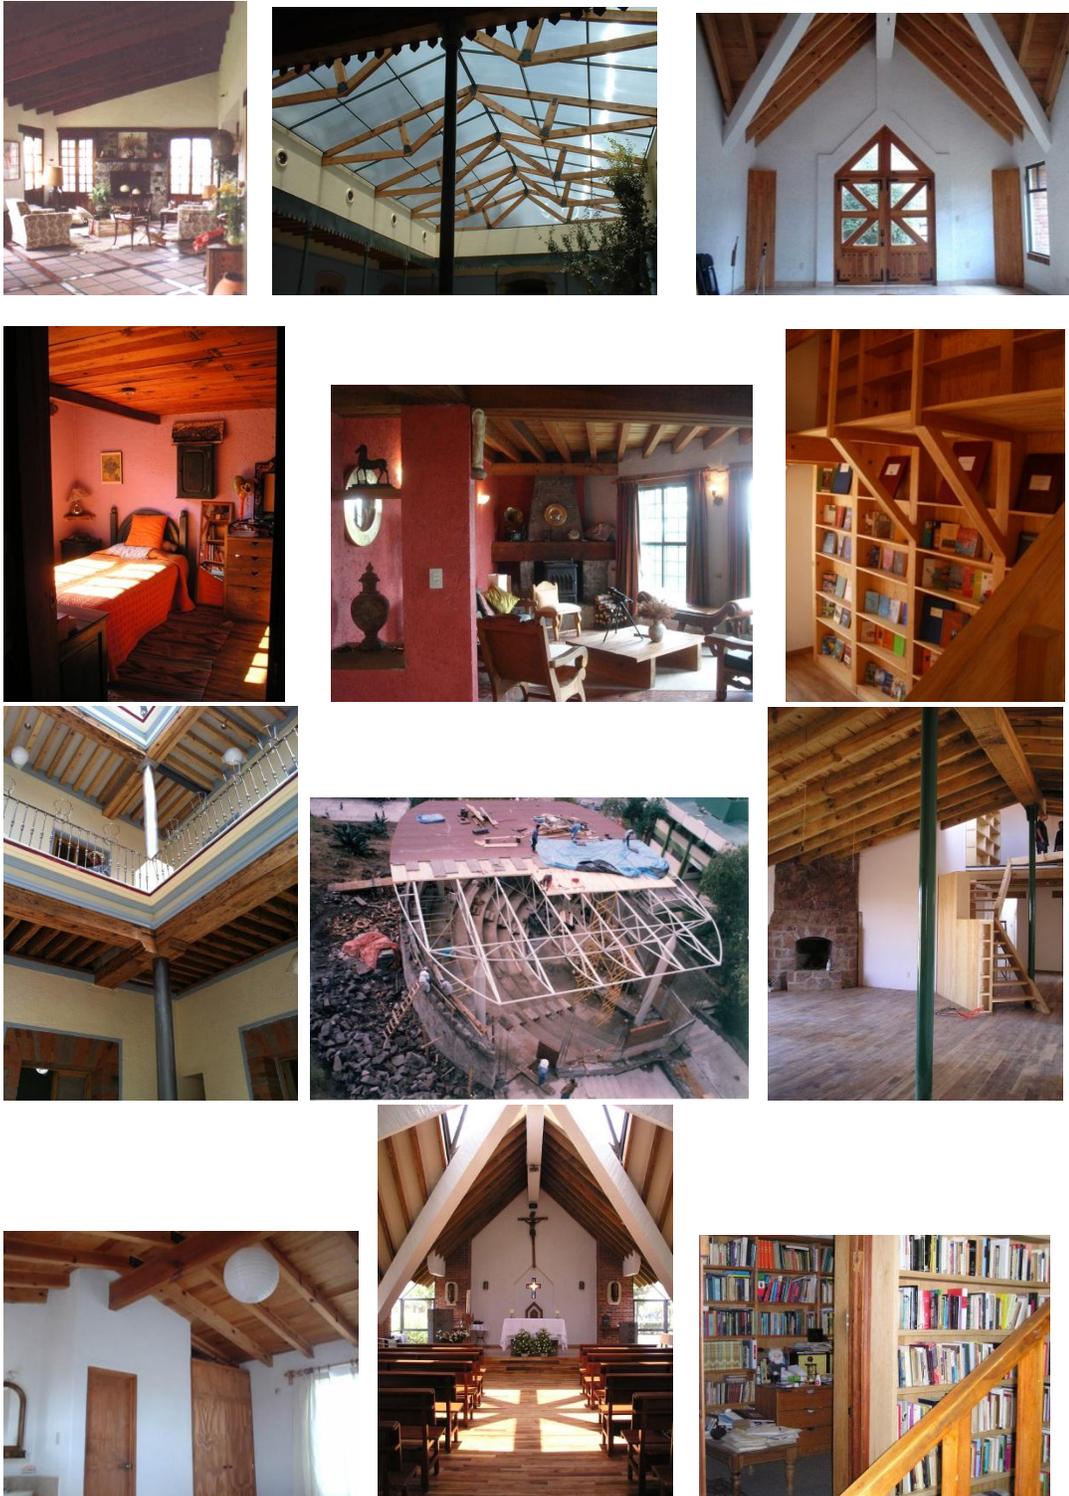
Obras construidas en madera sin utilización de cimbra de madera. (Fuente: Obras del autor en el Estado de México)
